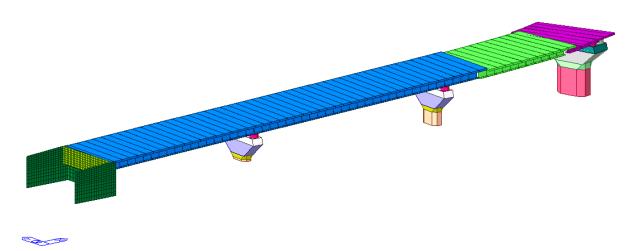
Vista 3D del modello di calcolo globale (Rampa C)
